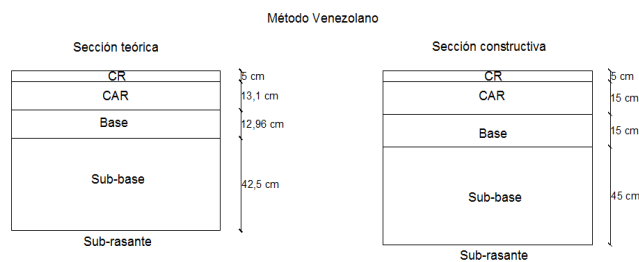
Diseño patrón. Estructura de pavimento. Método venezolano.
